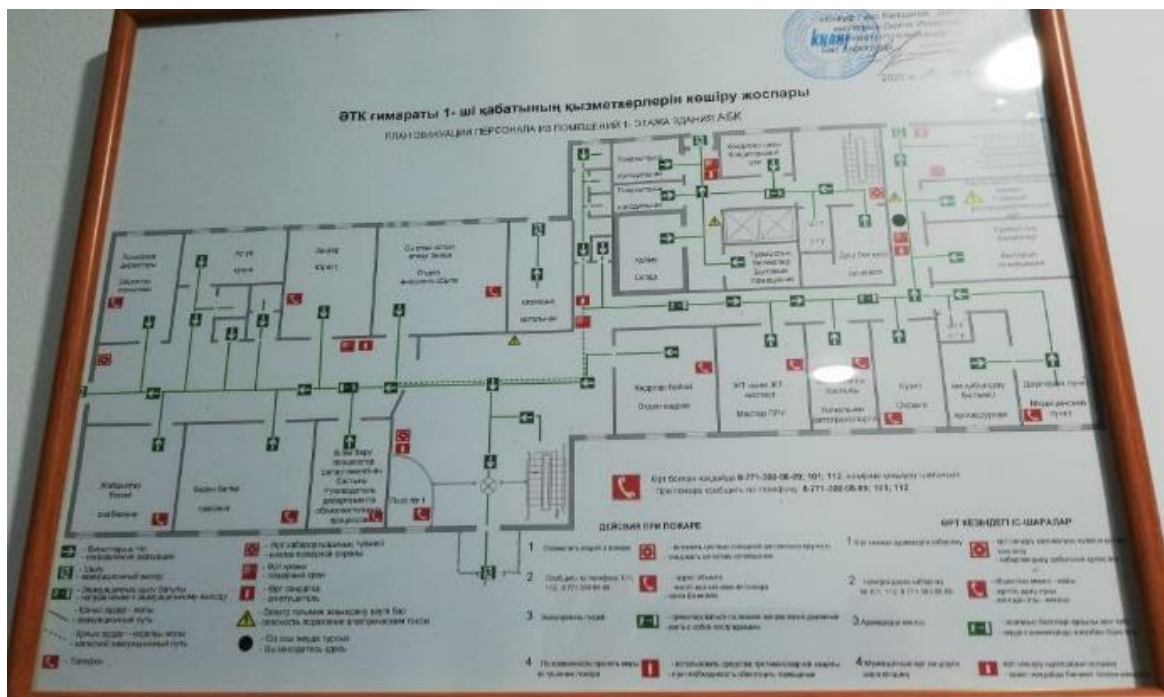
План эвакуации персонала из помещений 1-этажа здания АБК
